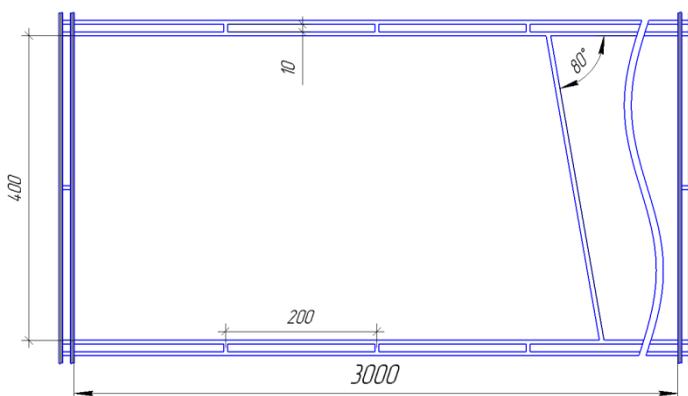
Схема подготовки выемочного участка двумя штреками
